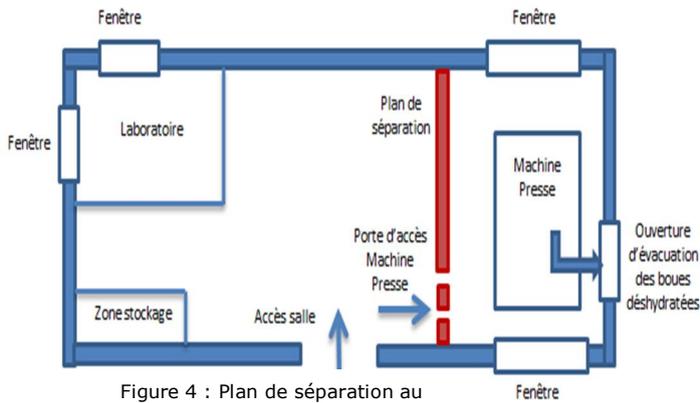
Plan de séparation au niveau de la salle de déshydratation
